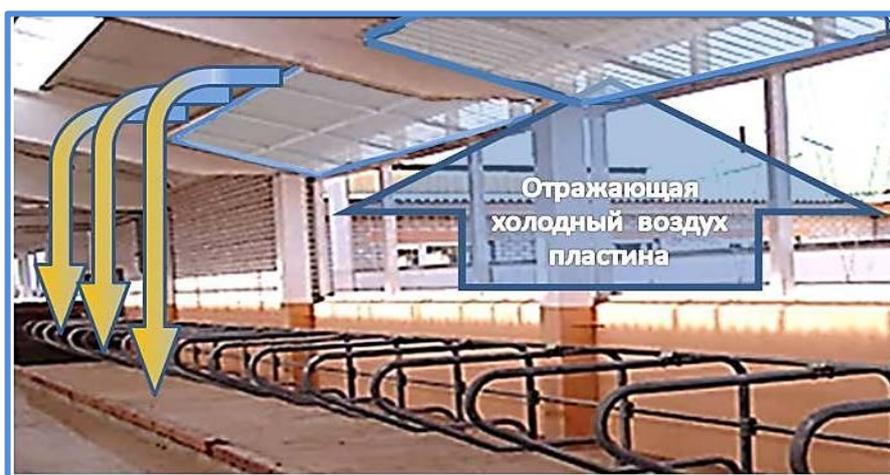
Схема движения воздуха при установке ветроотбойного щита
